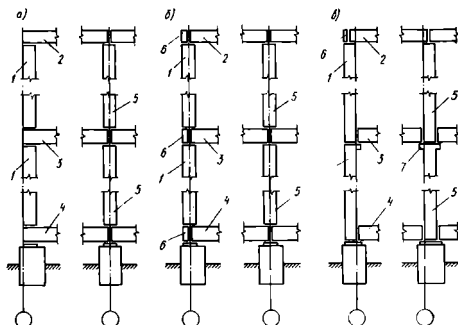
Варианты привязки наружных и внутренних несущих панельных стен к координационным осям:
